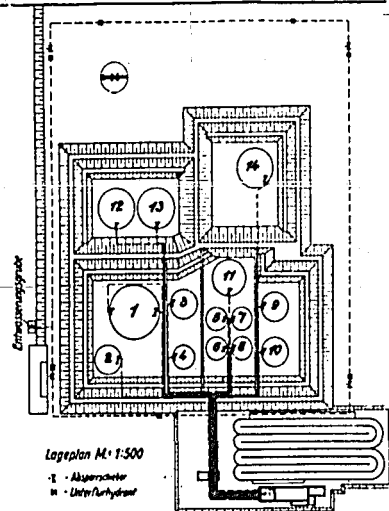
Grundriß einer Großtanklager-Feuerlöschanlage — Plan d'une installation d'incendie pour un grand entrepôt à réservoirs — Plan of a large scale tank store fire extinguishing plant
